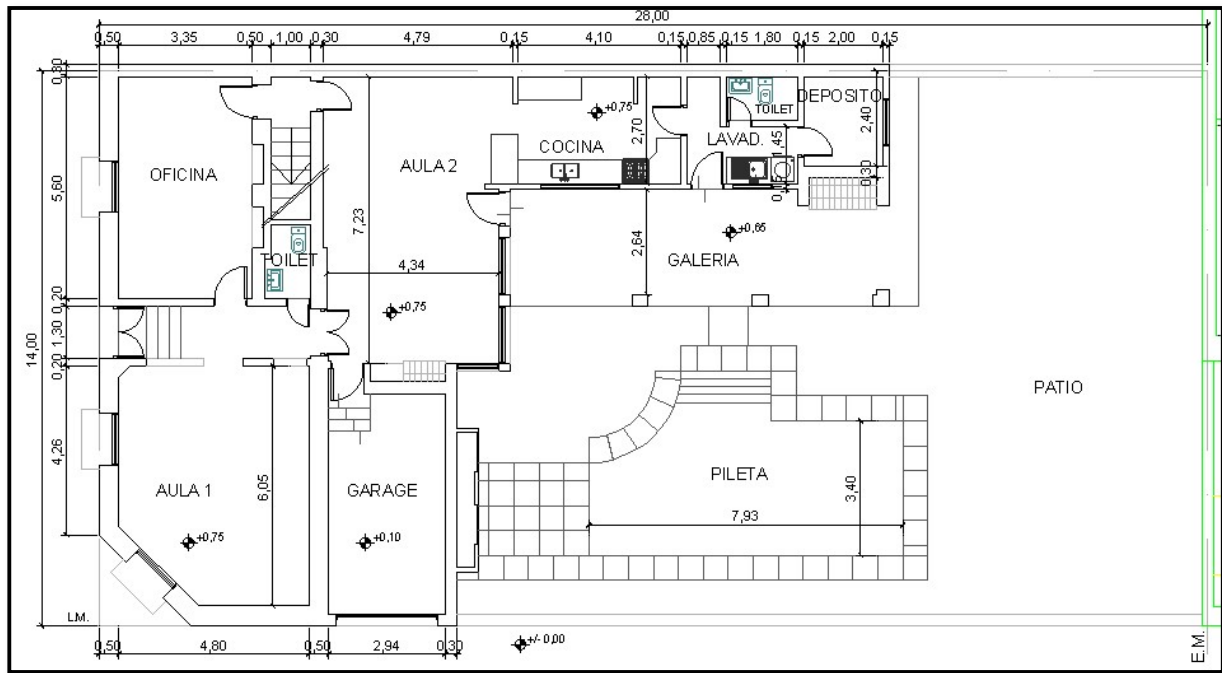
Plano de planta baja luego de la re funcionalización.
